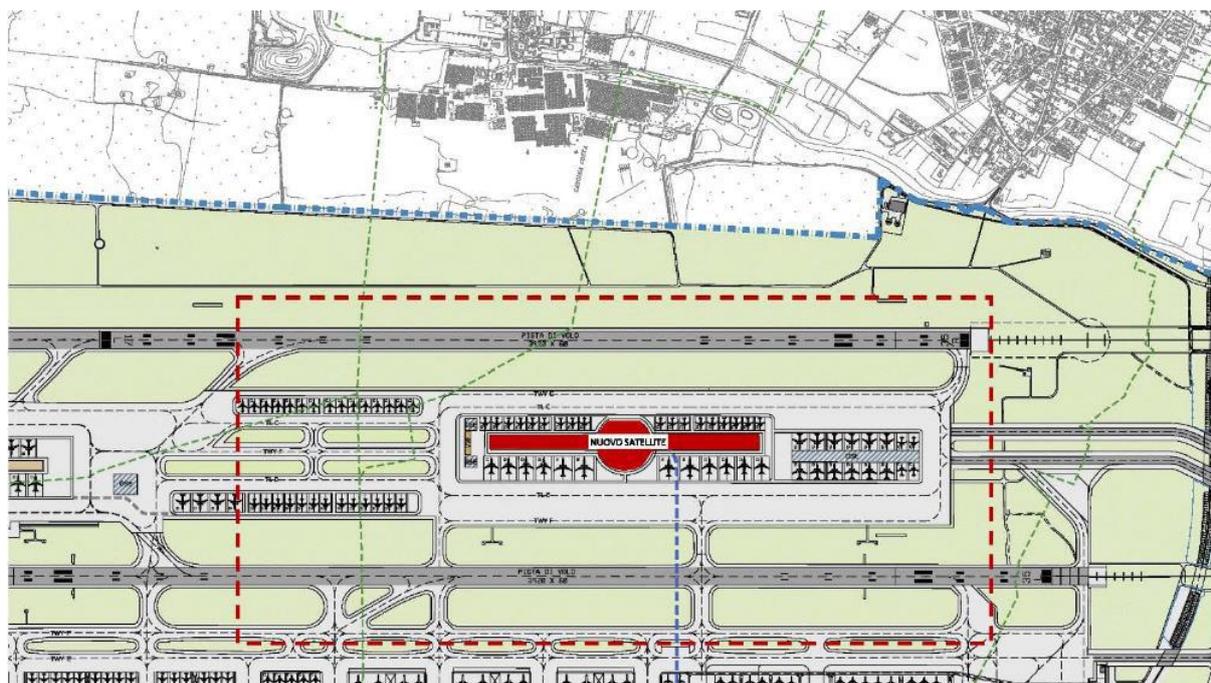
Ipotesi 3 schema di layout fonte: Masterplan 2035
